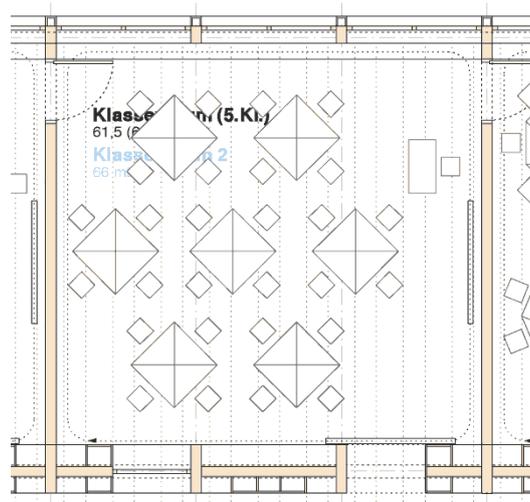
Klassenzimmer, 1. OG, Grundriss (ohne Maßstab)
